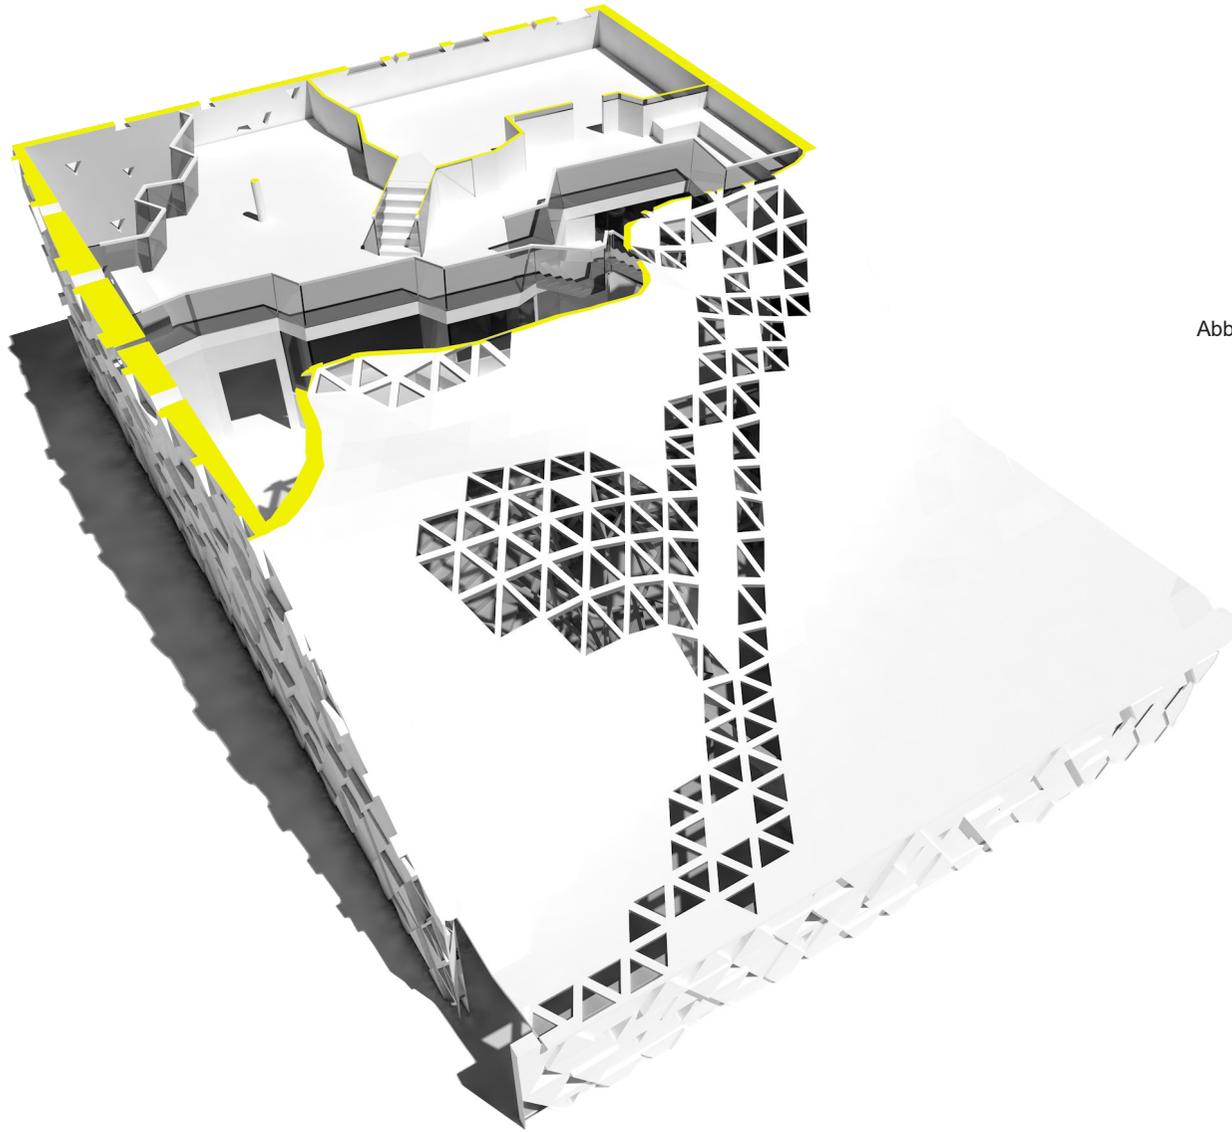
3D Darstellung 2.Obergeschoß
